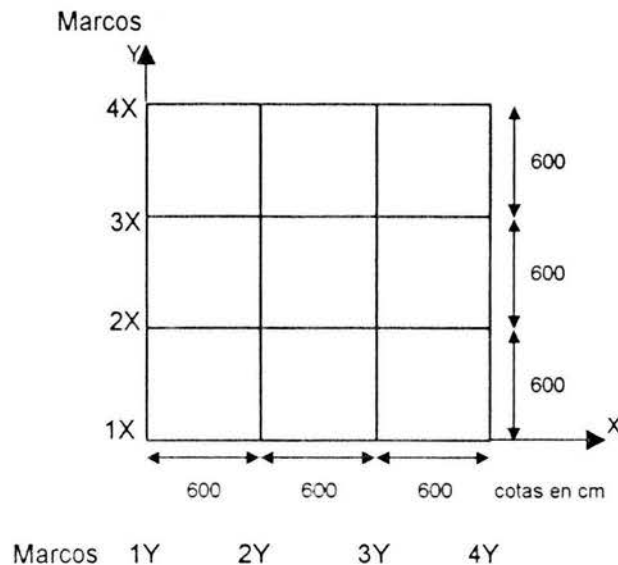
Distribución en planta de los marcos de un edificio simétrico de 10 pisos rígido.
